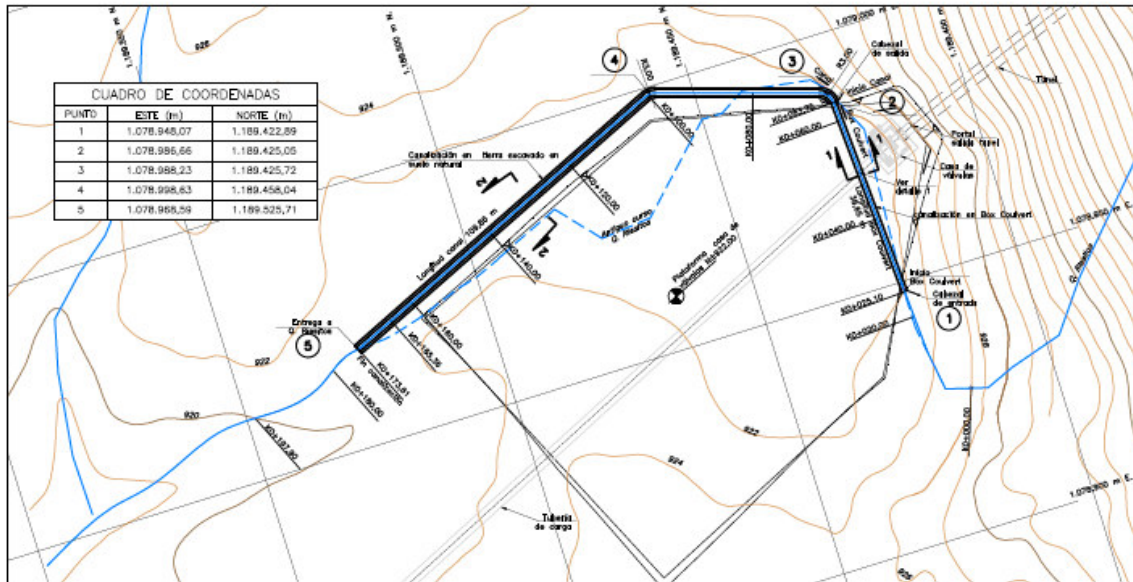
Planta perfil de canalización en portal de salida del túnel y casa de válvulas
